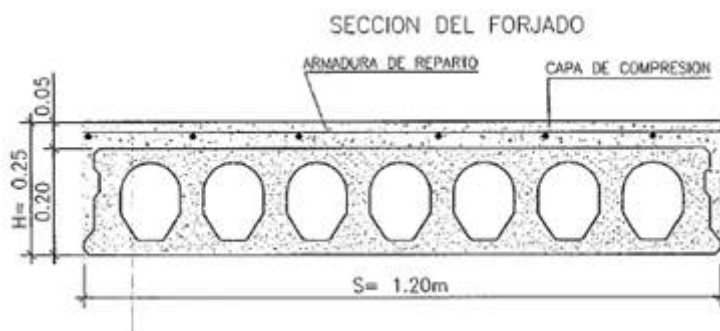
Detalle de la cubierta del depósito El Pinar
